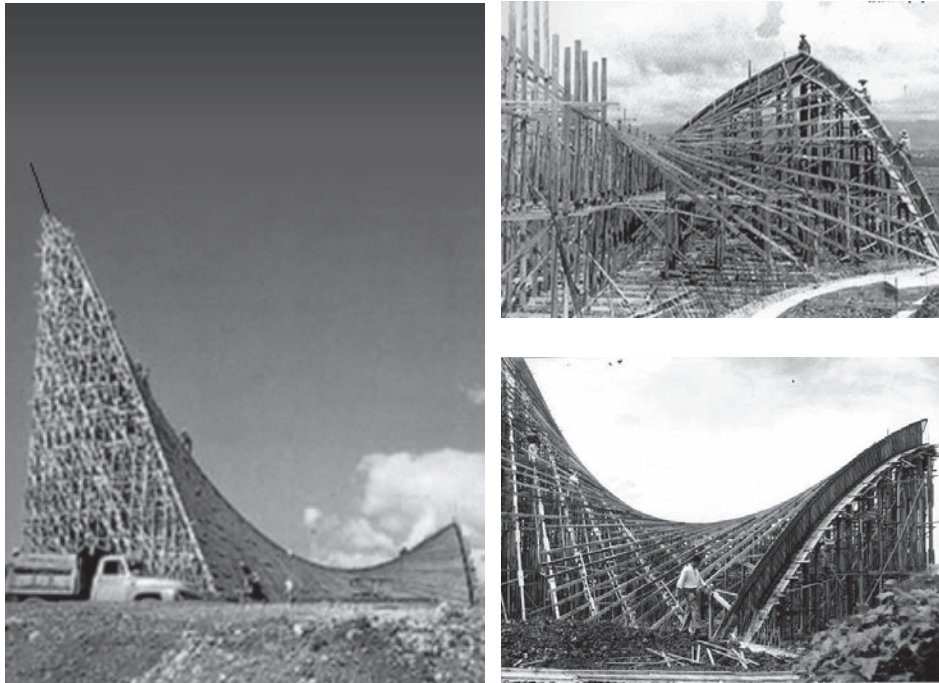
Secuencia de construcción de proyectos de Candela, que muestra el encofrado a partir de líneas rectas.
